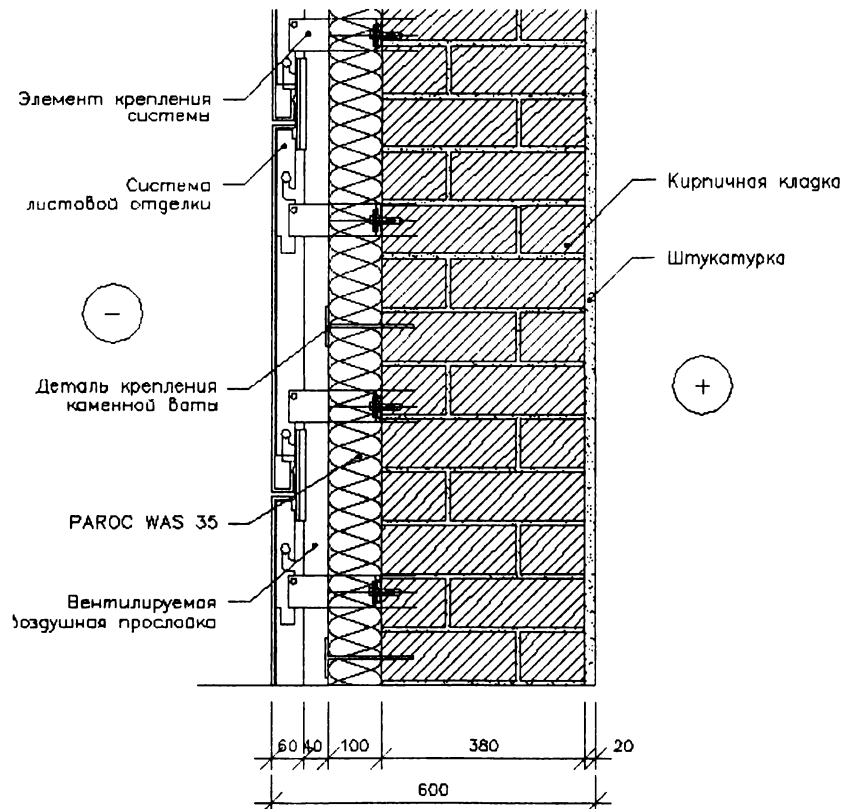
Утепление стены кирпичной кладки, применяя для системы плиту WAS 35
